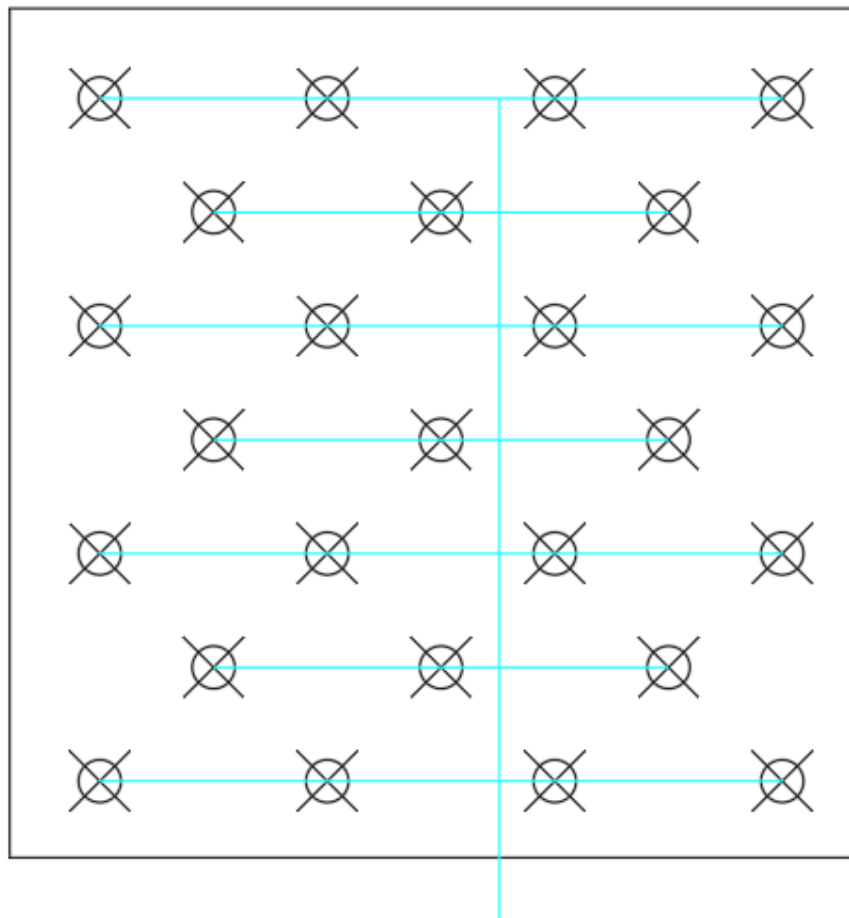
Arreglo alternativo propuesto. Realización propia mediante AutoCAD.
